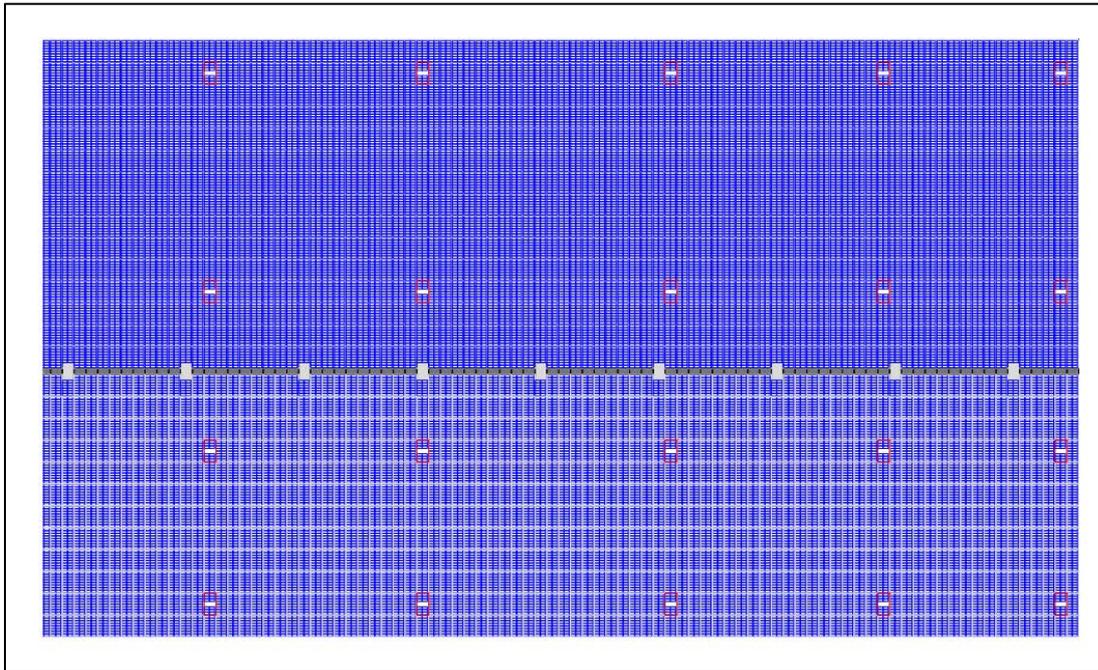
Layout Hauptanlage mit 21,29 MWp | Quelle: Zimmermann PV Floating
